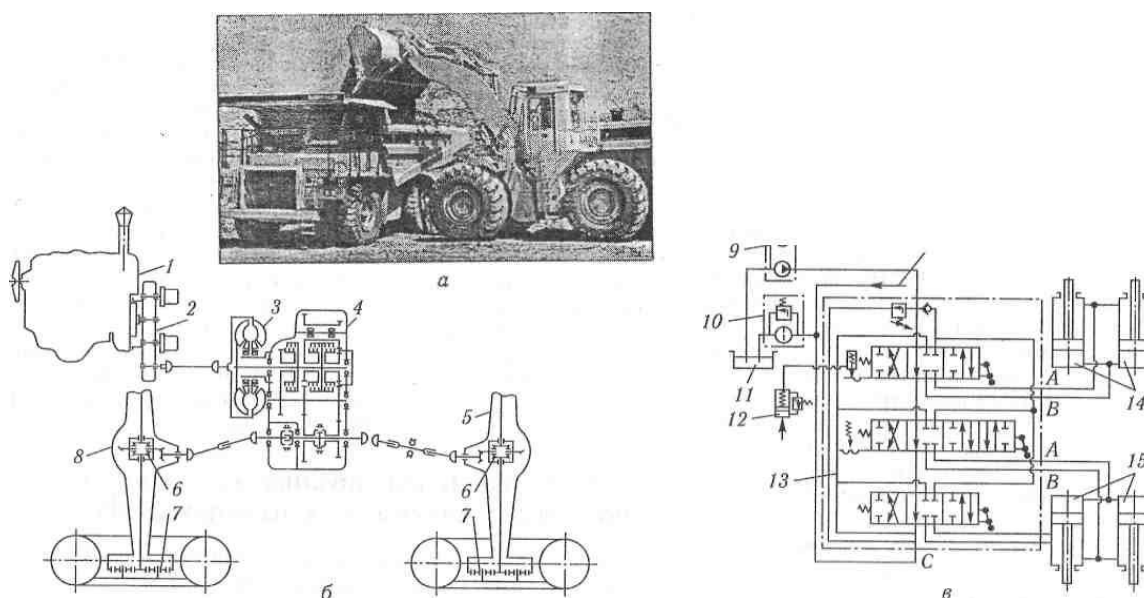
Одноківшевий навантажувач: *а* – загальний вигляд; *б* – кінематична схема: 1 – двигун; 2 – коробка відбору потужності; 3 – гідротрансформатор; 4 – коробка передач; 5 – передній міст; 6 – головна передача; 7 – ступінчастий редуктор; 8 – задній міст; *в* – гідросхема: 9 – насос; 10 – фільтр; 11 – масляний бак; 12 – гідровимикач; 13 – розподільник; 14 – циліндри ковша; 15 – циліндри стріли
